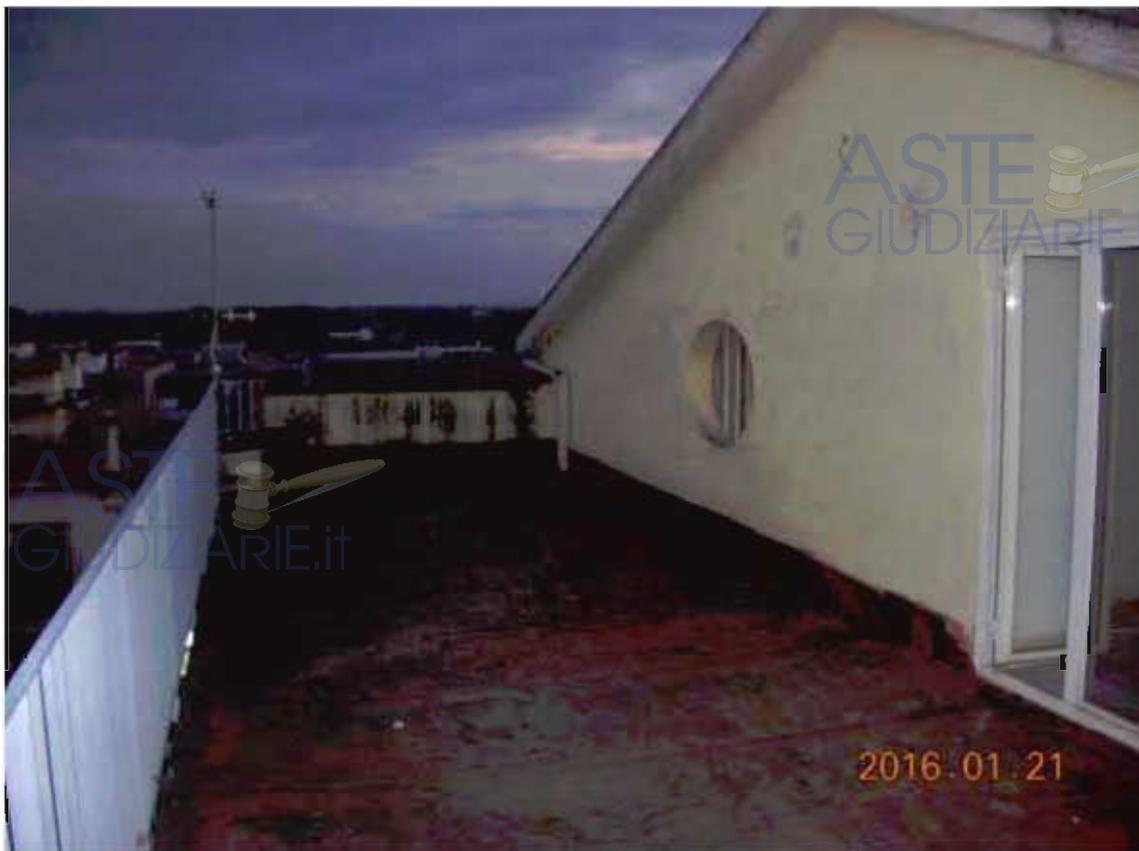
Terrazzino Est del piano terzo/sottotetto
